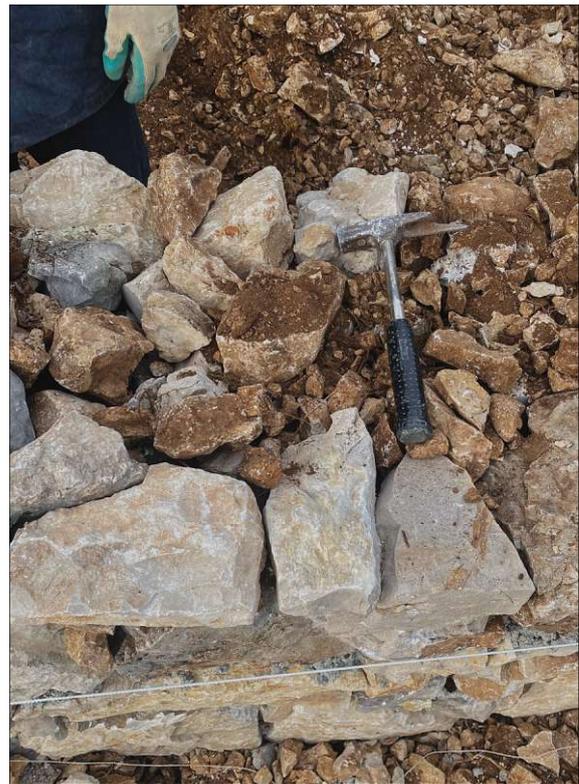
Der Trockenbau, Konjsko, ein Werkzeug für die grobe Bearbeitung von Steinen während des Baus
